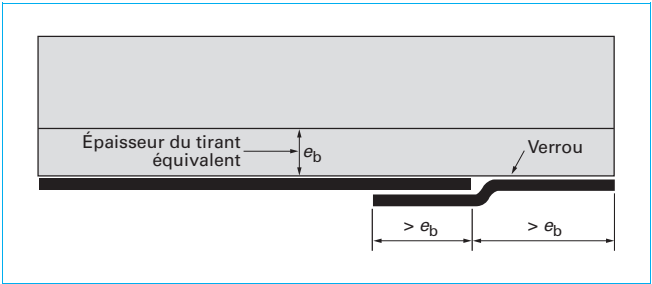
Exemple de verrou dans le cas de renforcement au moment fléchissant
